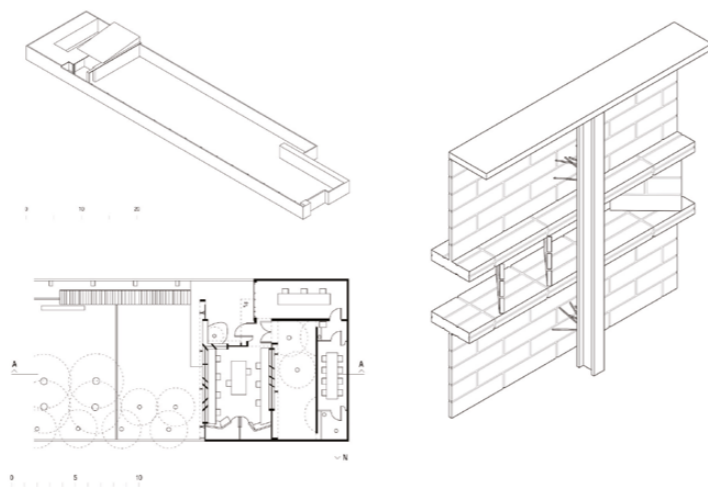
Fachada principal de la antigua sede del Gabinete de Arquitectura (1994). Fuente: Enrico Cano ([www.enricocano.com/solano-benitez](http://www.enricocano.com/solano-benitez)). | Figura 2. Perspectiva isométrica, planta baja y detalle de la fachada de la antigua sede del Gabinete de Arquitectura (1994). Fuente: Dibujos de la autora.
